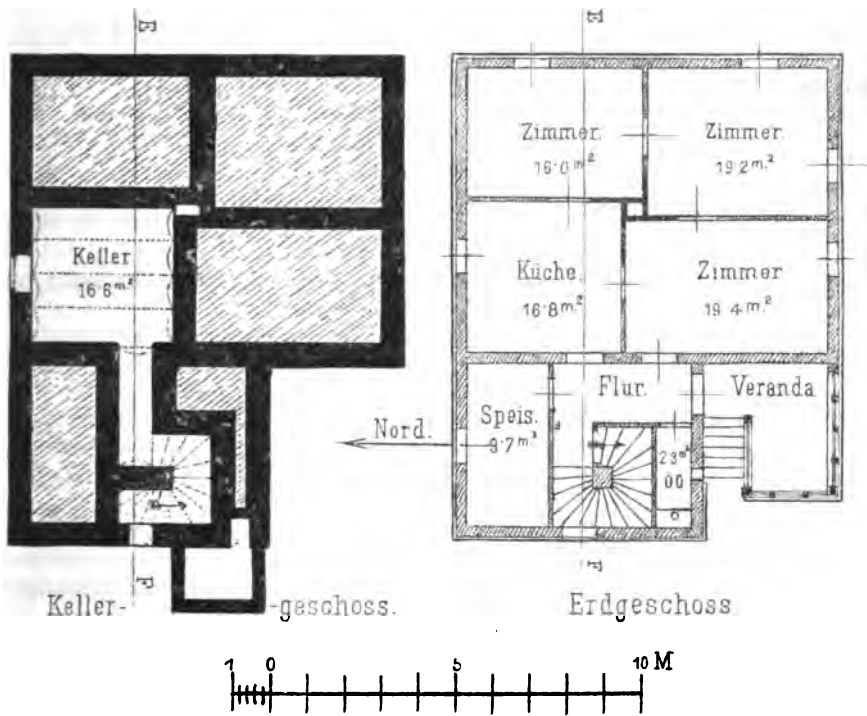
u. 16. Grundrisse des Keller- und Erdgeschosses.
